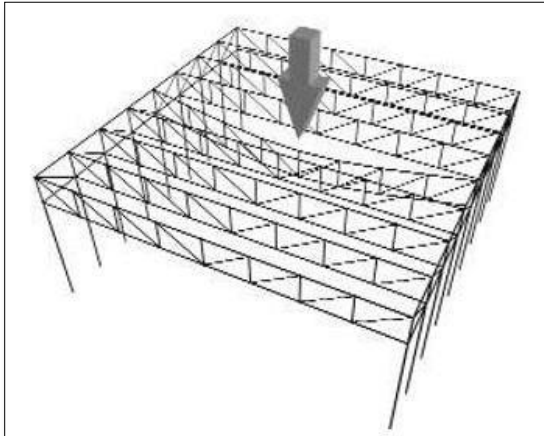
un point d'appui soutenu par une poutre simplement appuyée
